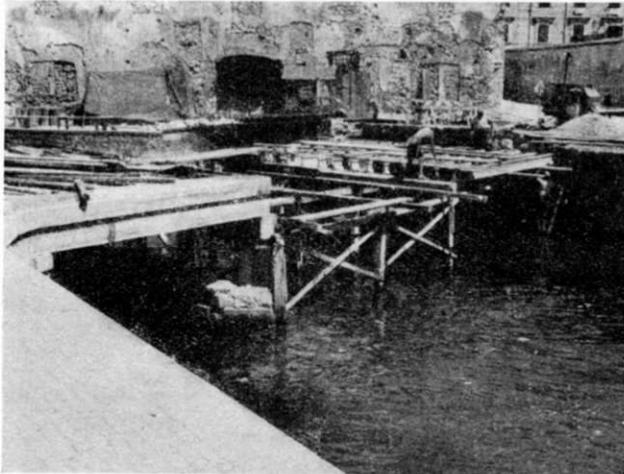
Ponte dell'ospedale sul canale di Terracina in costruzione.
